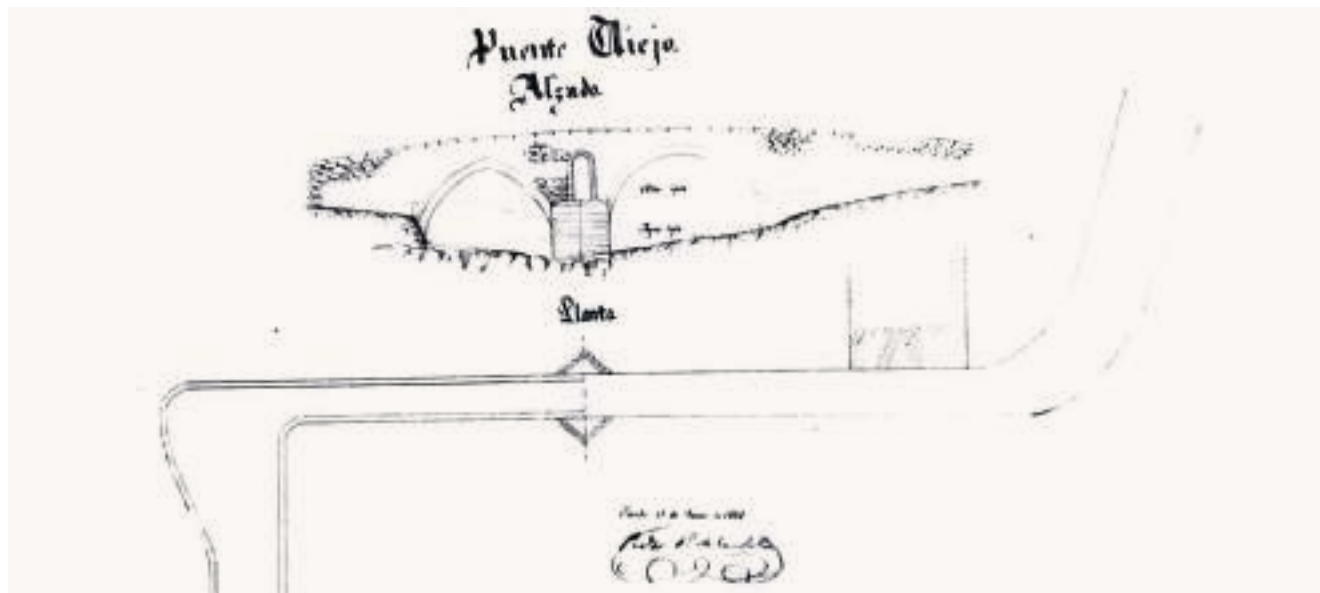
Alzado del siglo XIX, en el que se observa la casa adosada al estribo, al lado de la carretera. (AGA)
